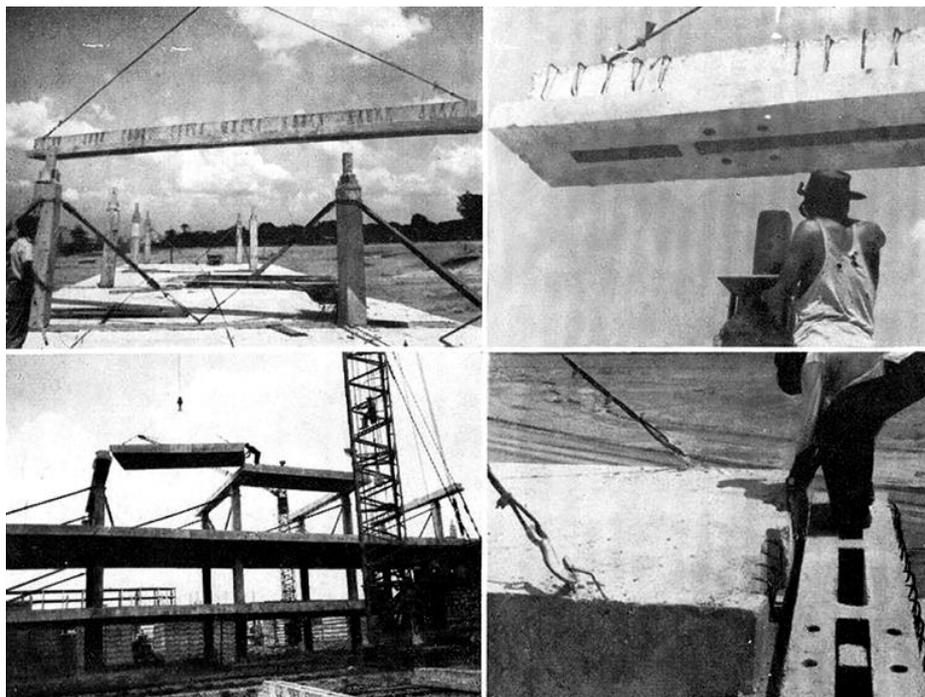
Montagem dos sistemas de estruturas do CRUSP. As vigas de seção “T” invertidas com rasgos para encaixe dos pilares
